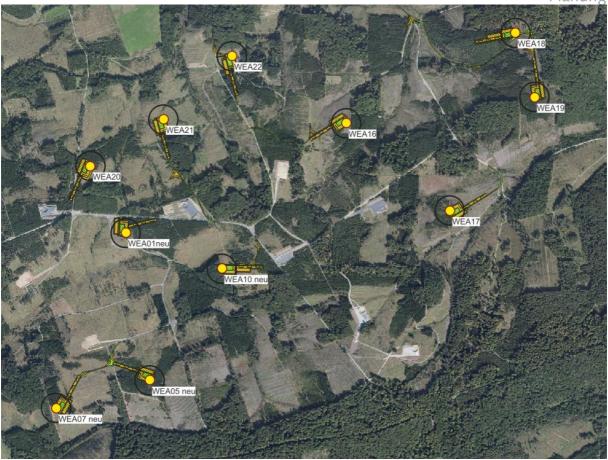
Übersicht der Kranstellflächen, Fundamente und Lager-/Montageflächen.
